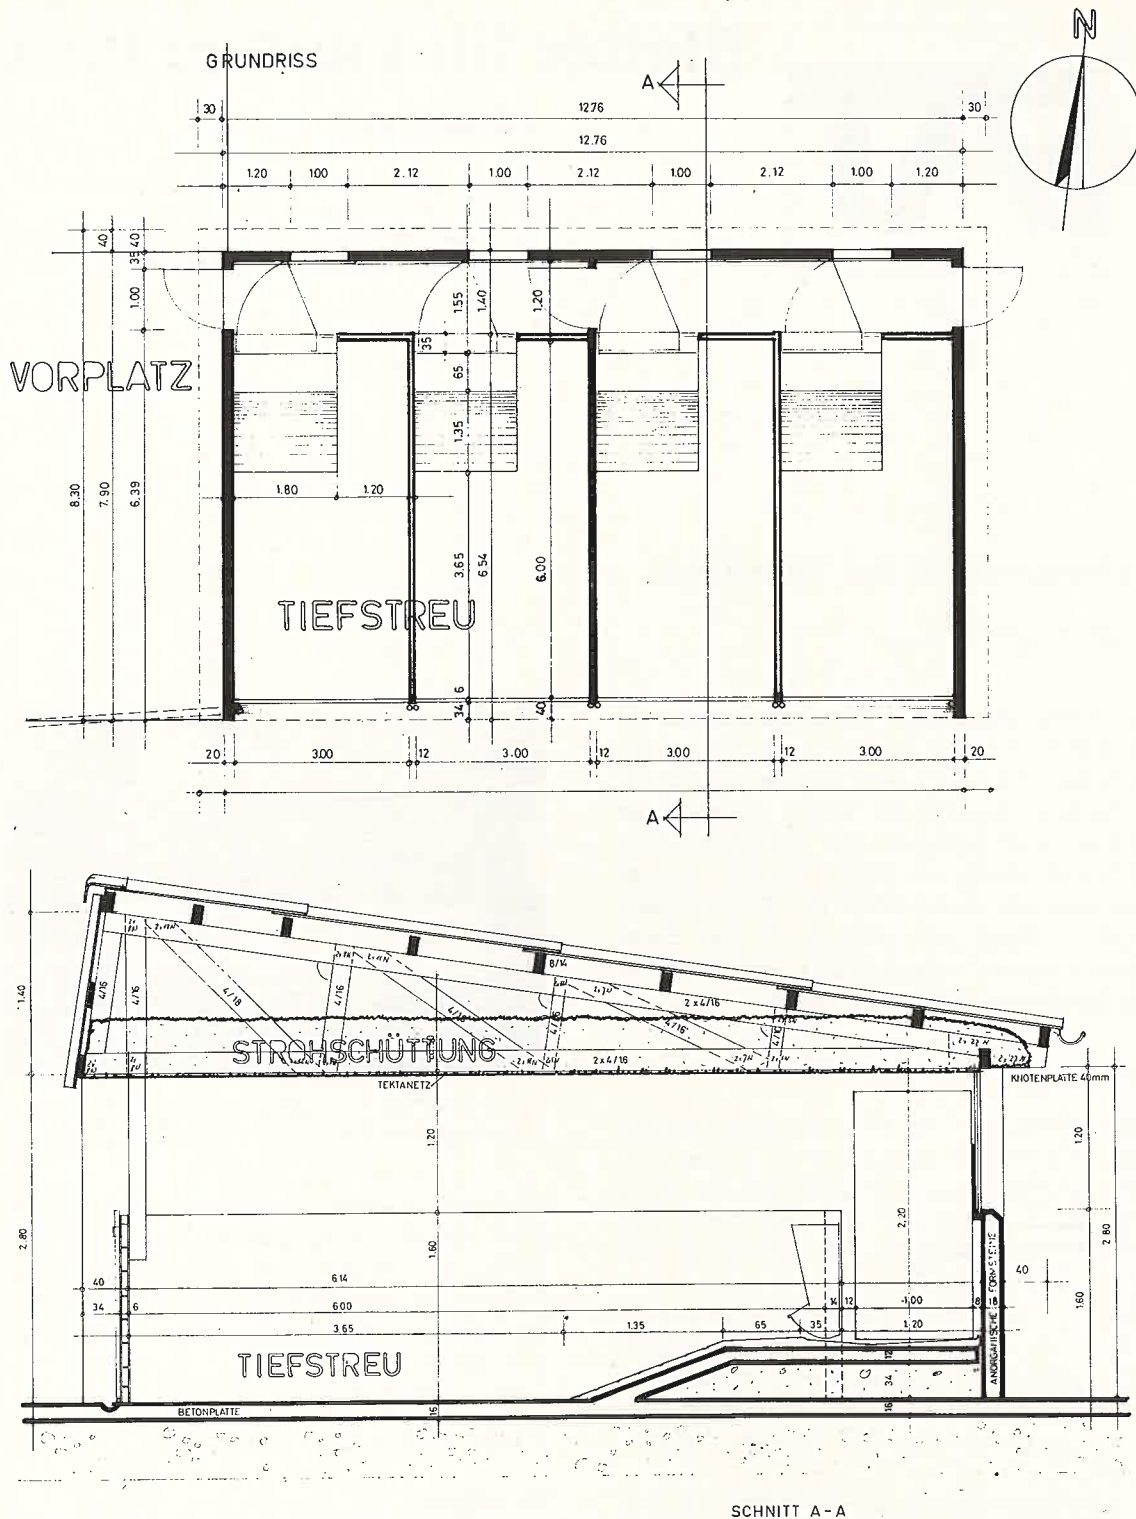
Grundriss und Schnitt des Offenfrontstalles.
